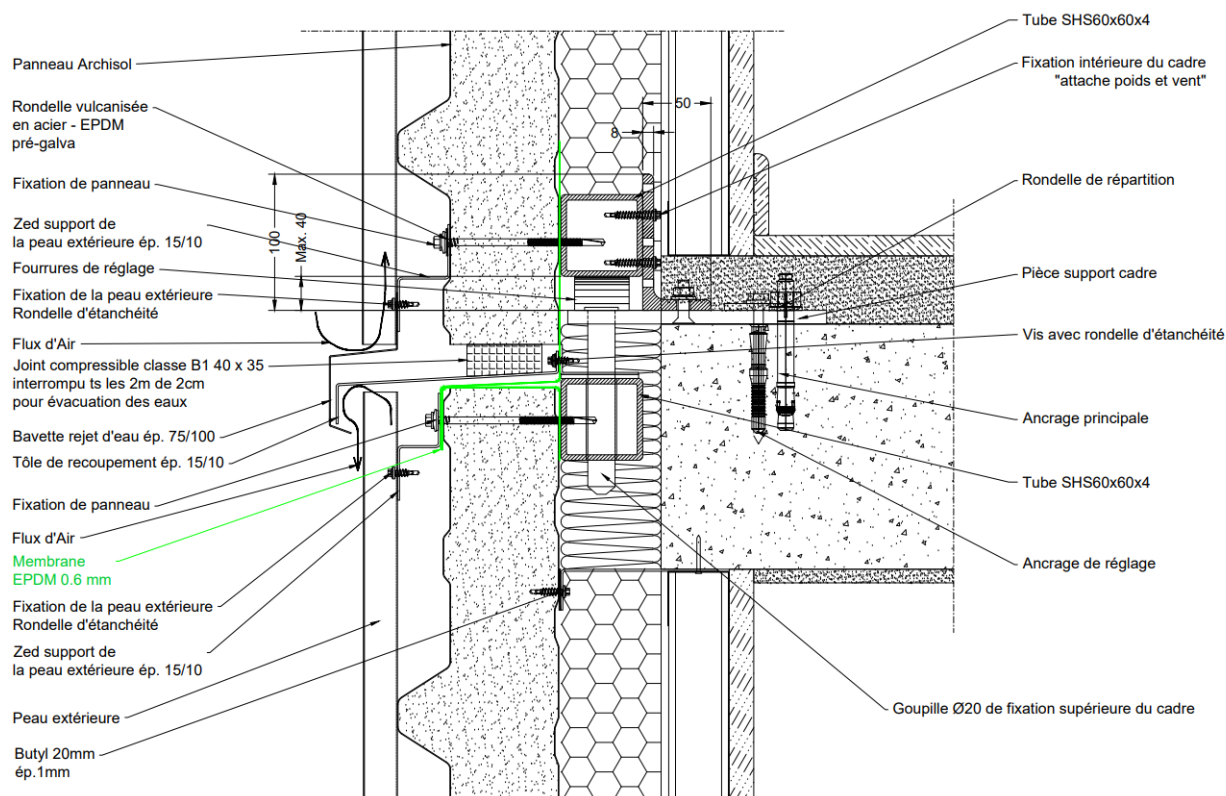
Coupe verticale sur la jonction horizontale entre modules D2B Archisol – Ancrage de rive (poids et vent) - Pose directe
